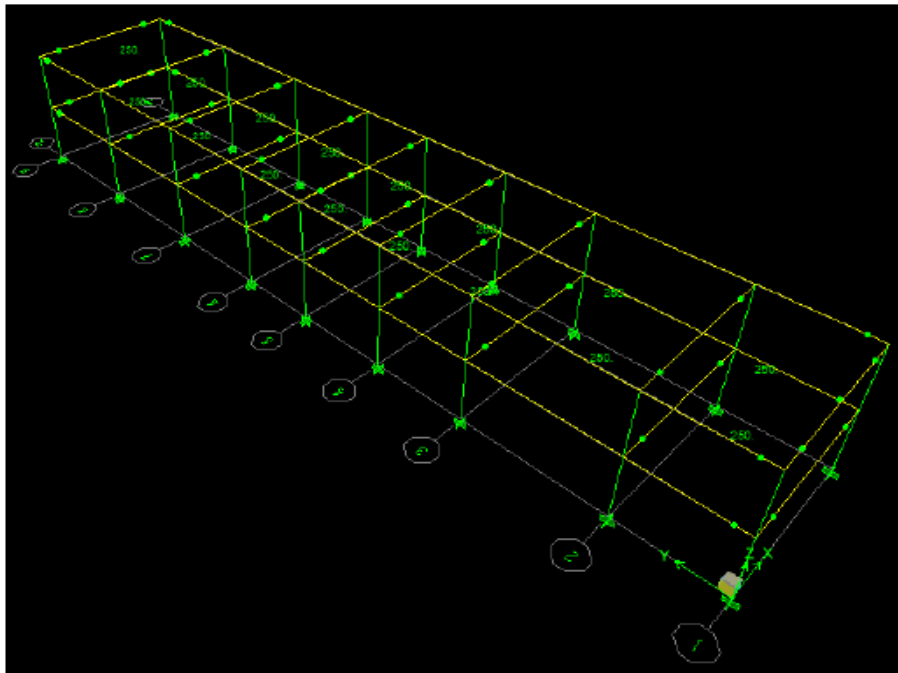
Distribución de Cargas Muertas Sobre Losas - Bloque 2
